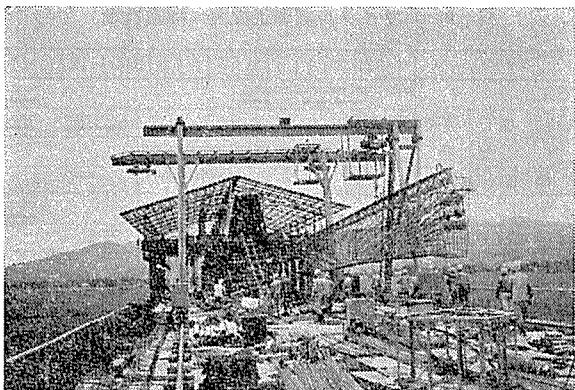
腹部鉄筋の搬入 (ゲリュースト ワーゲン)
